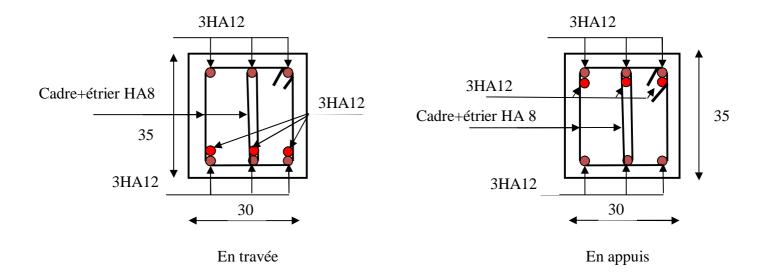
Schéma de ferraillage de la poutre secondaire pour la terrasse inaccessible.
